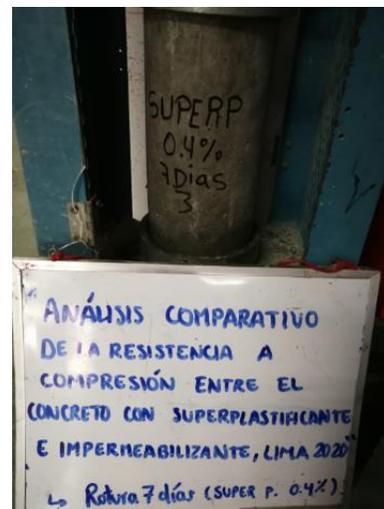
Rotura de probetas del concreto con impermeabilizante 0.4% a los 7 días.
